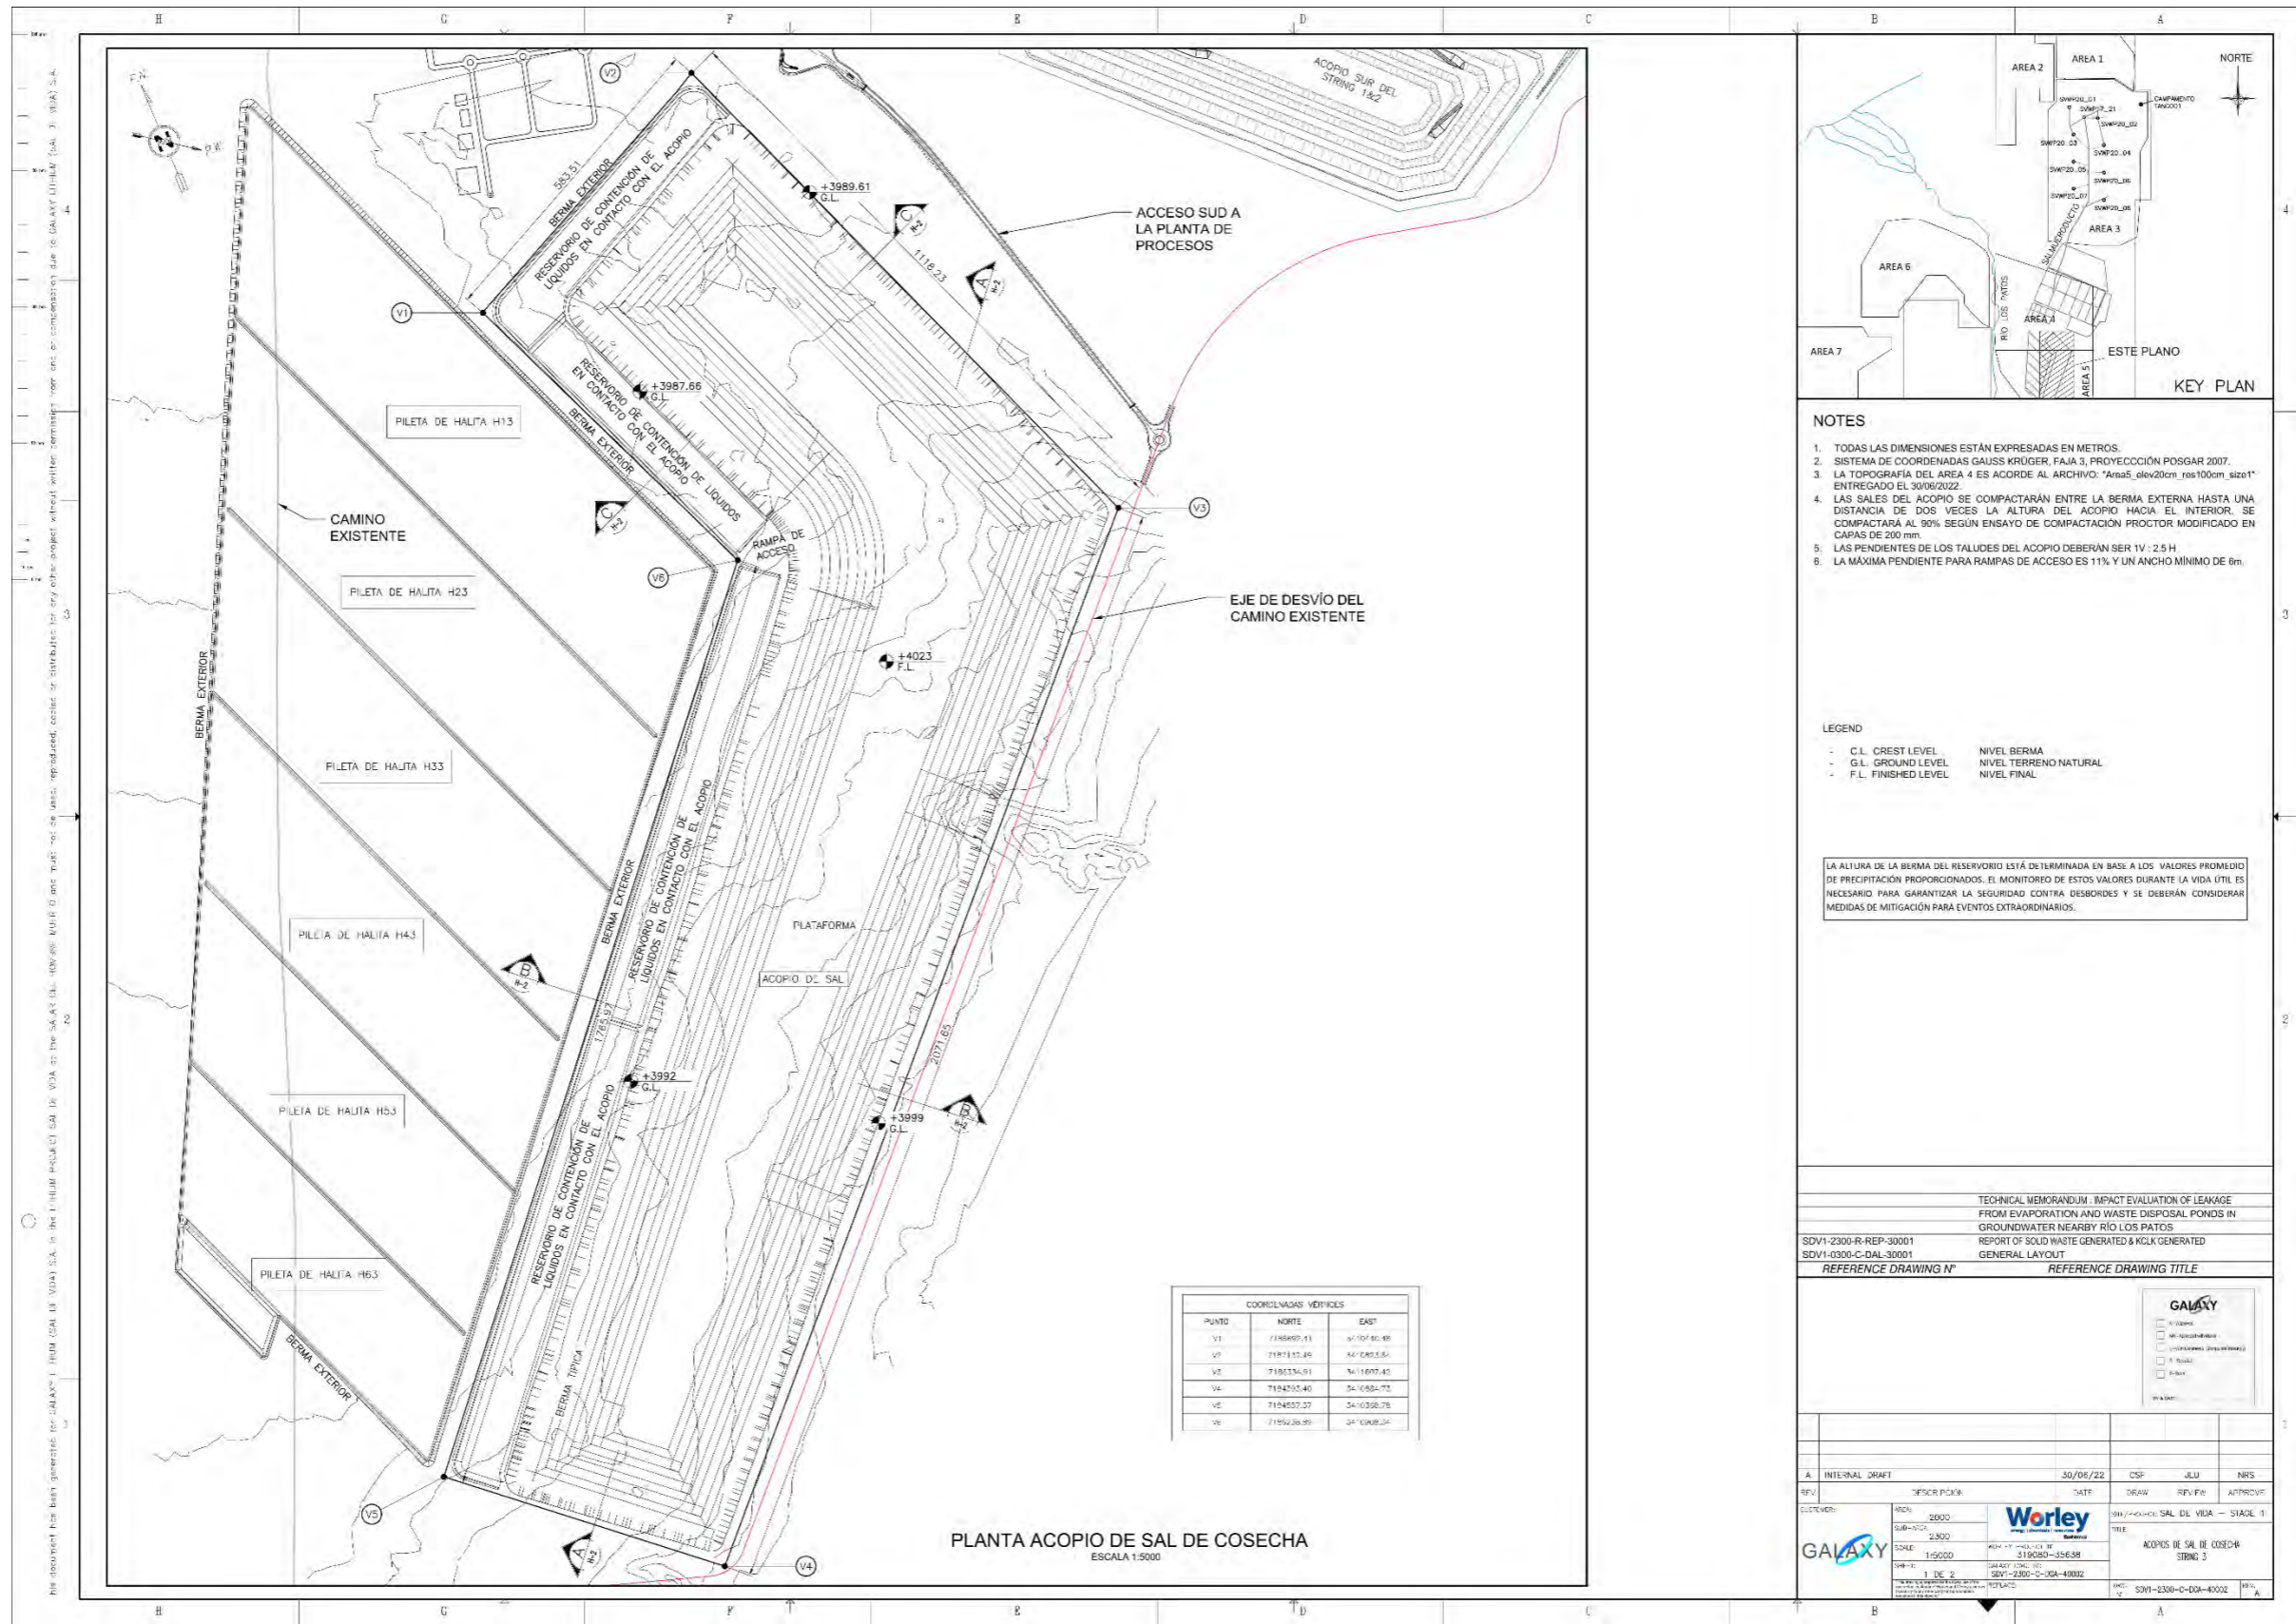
Plano del Área de acopio de sales de cosecha String 3.
